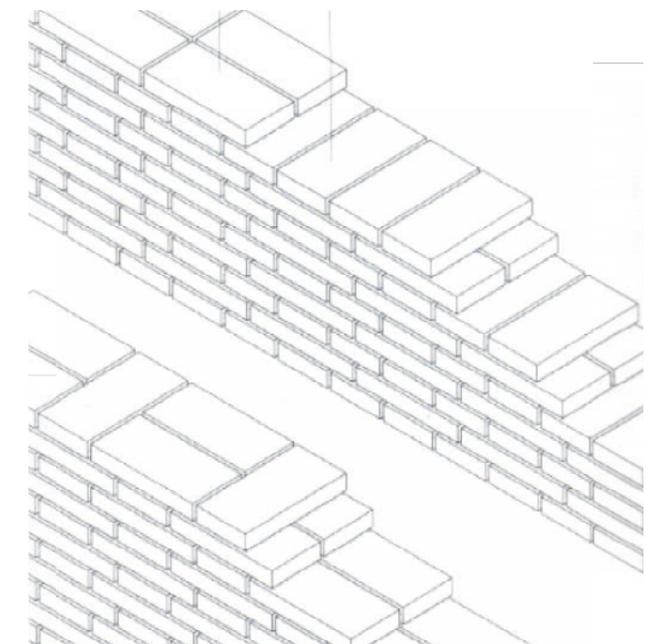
Detalle muro de ladrillo. (Vegas & Mileto, 2011)
